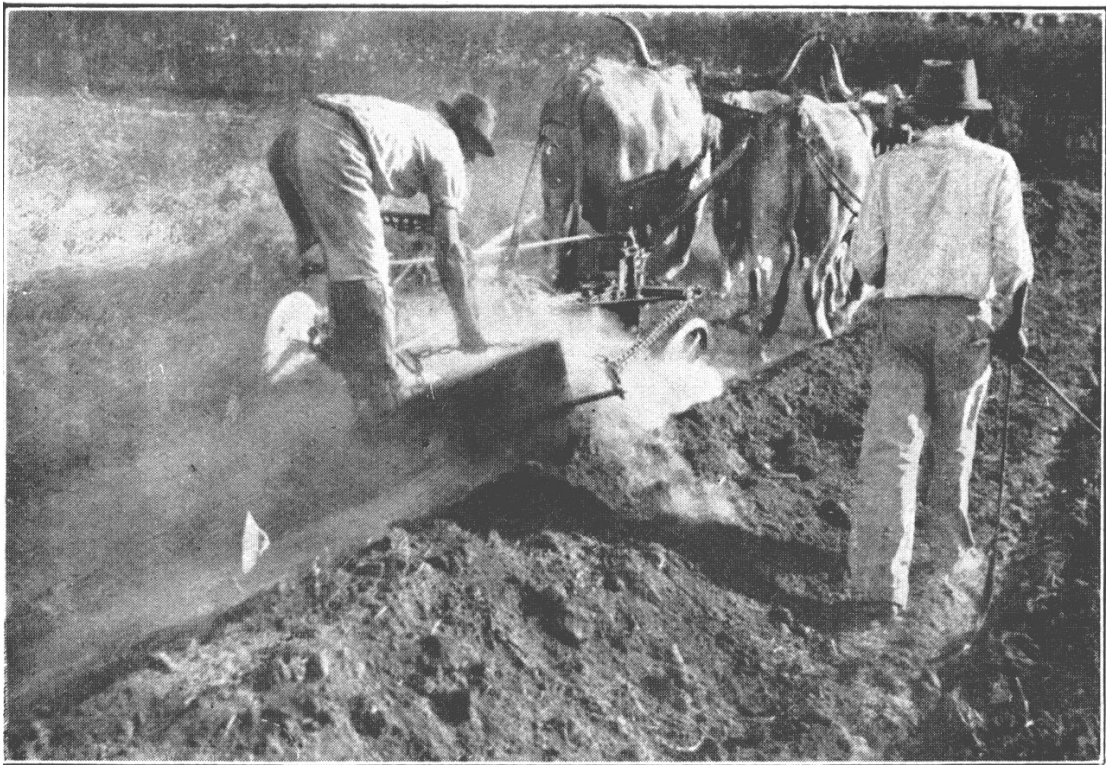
Vista de conjunto sendo tracionado por 4 bois em trabalho de construção de um dique para irrigação. (Foto do autor.)
